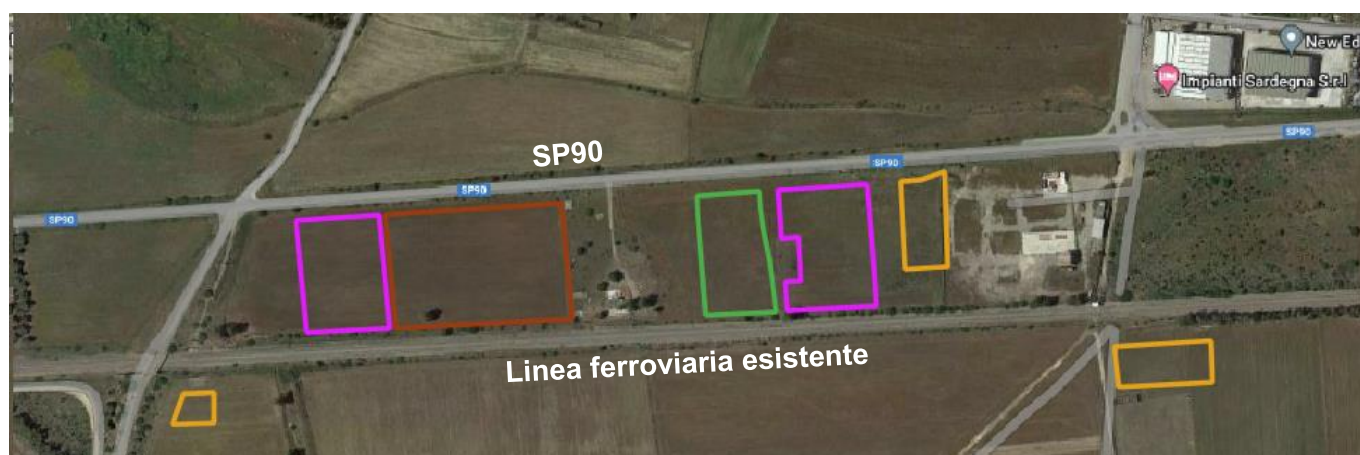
Localizzazione delle aree di cantiere fisso
